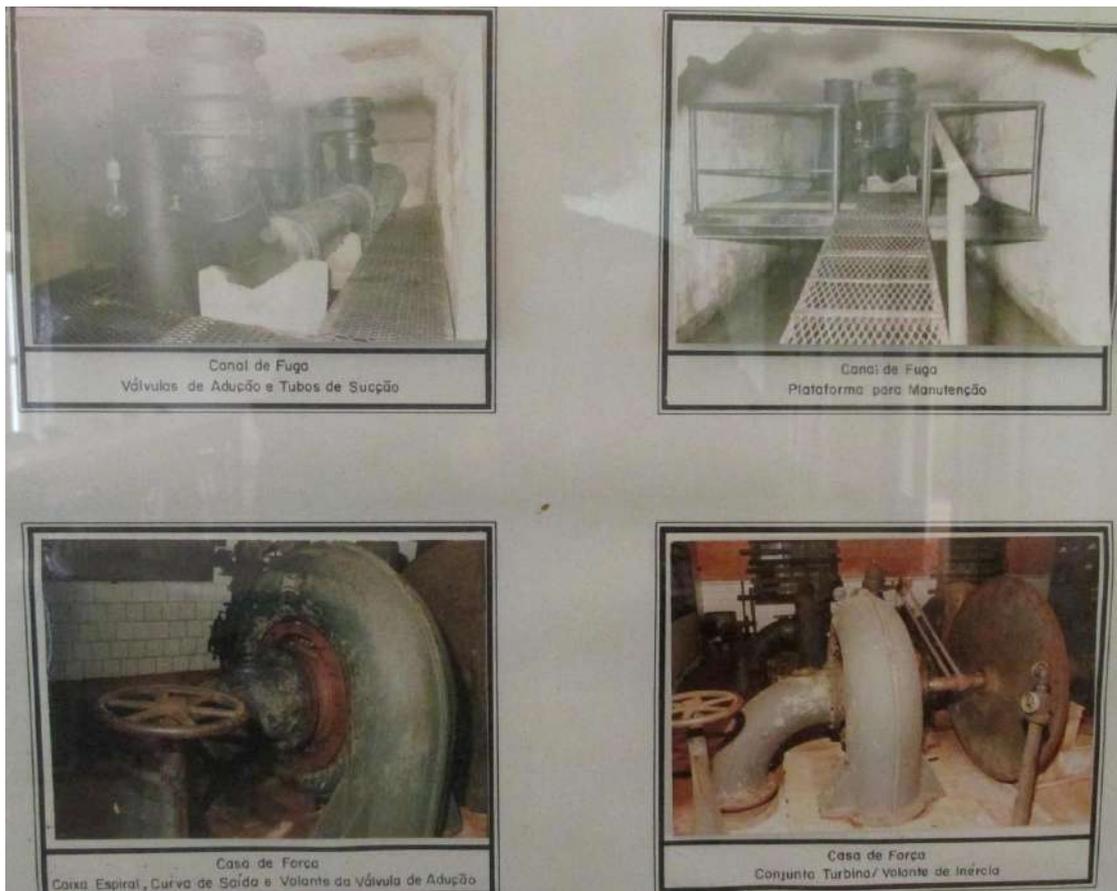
Válvulas de adução, tubos de sucção e plataforma canal de fuga
